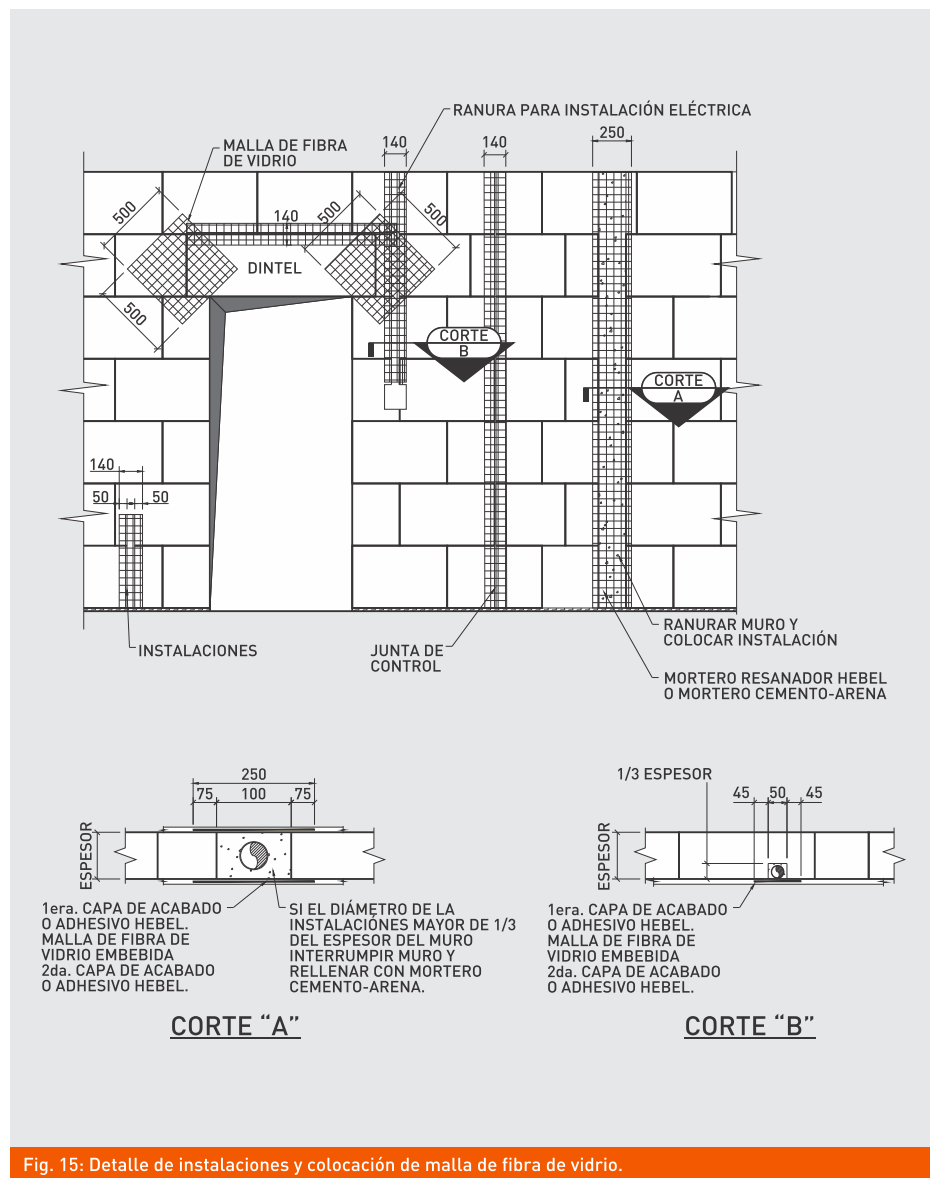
Detalle de instalaciones y colocación de malla de fibra de vidrio.
